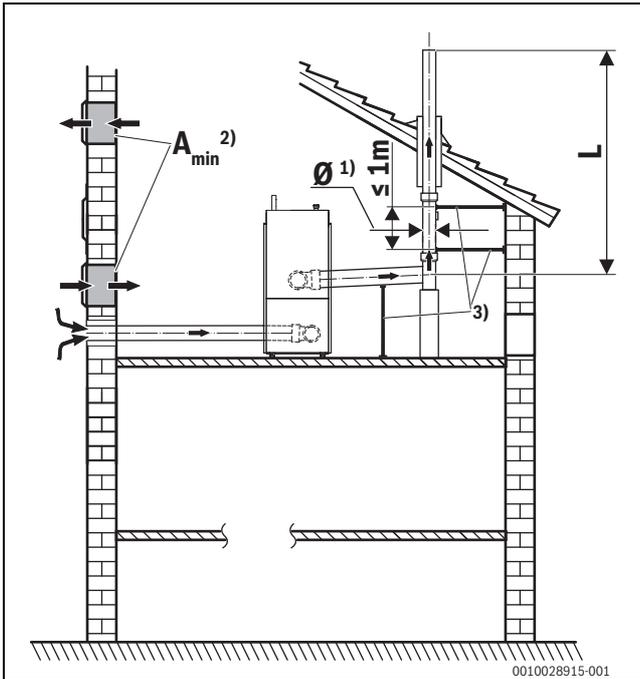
Wirksame Höhe der Abgasleitung, ohne Schacht, Dachzentrale, Variante 3
